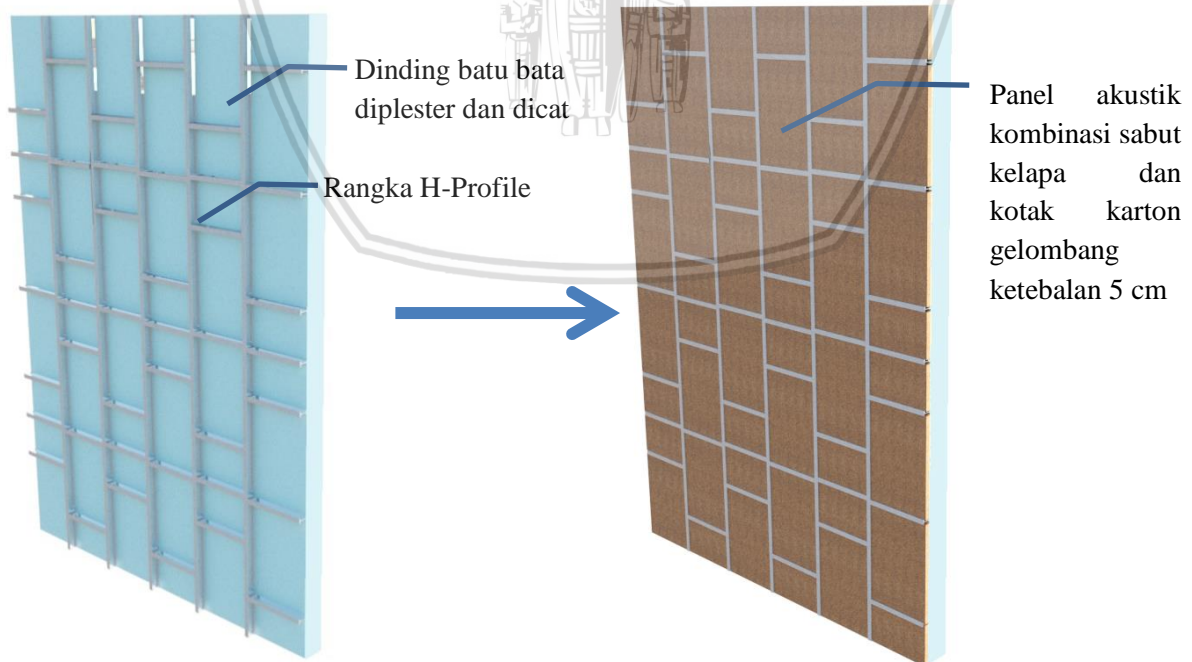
perletakan panel pada facade belakang ruang kelas 5 dan 6
